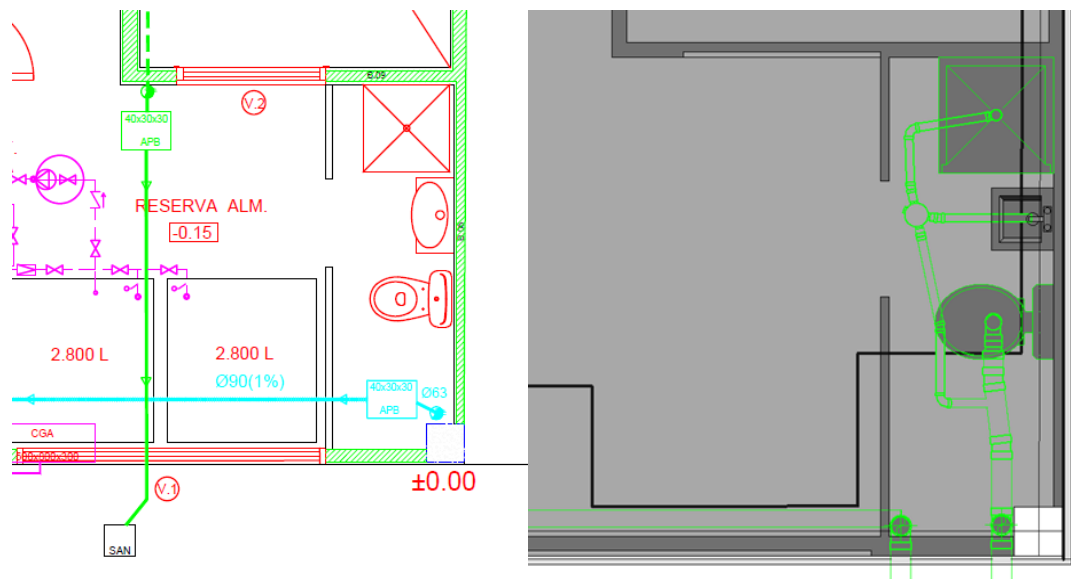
Baño planta semisótano, modelo en BIM. Fuente: Proyecto original y elaboración propia.
